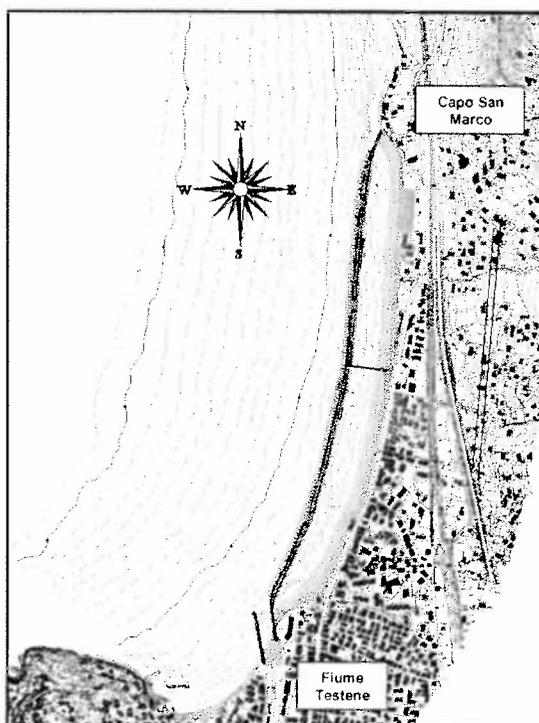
Planimetria dell'intervento. Si possono distinguere sia la scogliera sommersa che i tre pennelli
